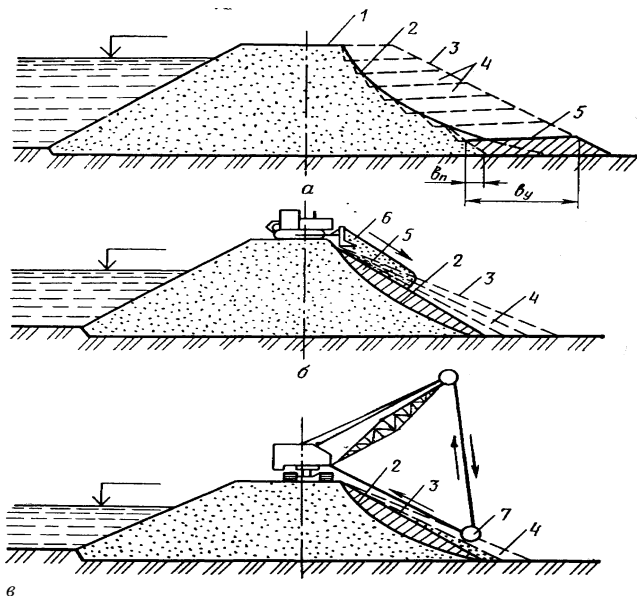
Схема уширения и уположивания откосов грунтовых плотин: а и б – продольный и поперечный способы; в – уплотнение грунта катком; 1 – гребень плотины; 2 – низовой откос до ремонта; 3 – проектный откос; 4 – слой отсыпки и уплотнение грунта; 5 – уплотненный грунт; 6 – грунт, разравниваемый бульдозером; 7 – каток.
